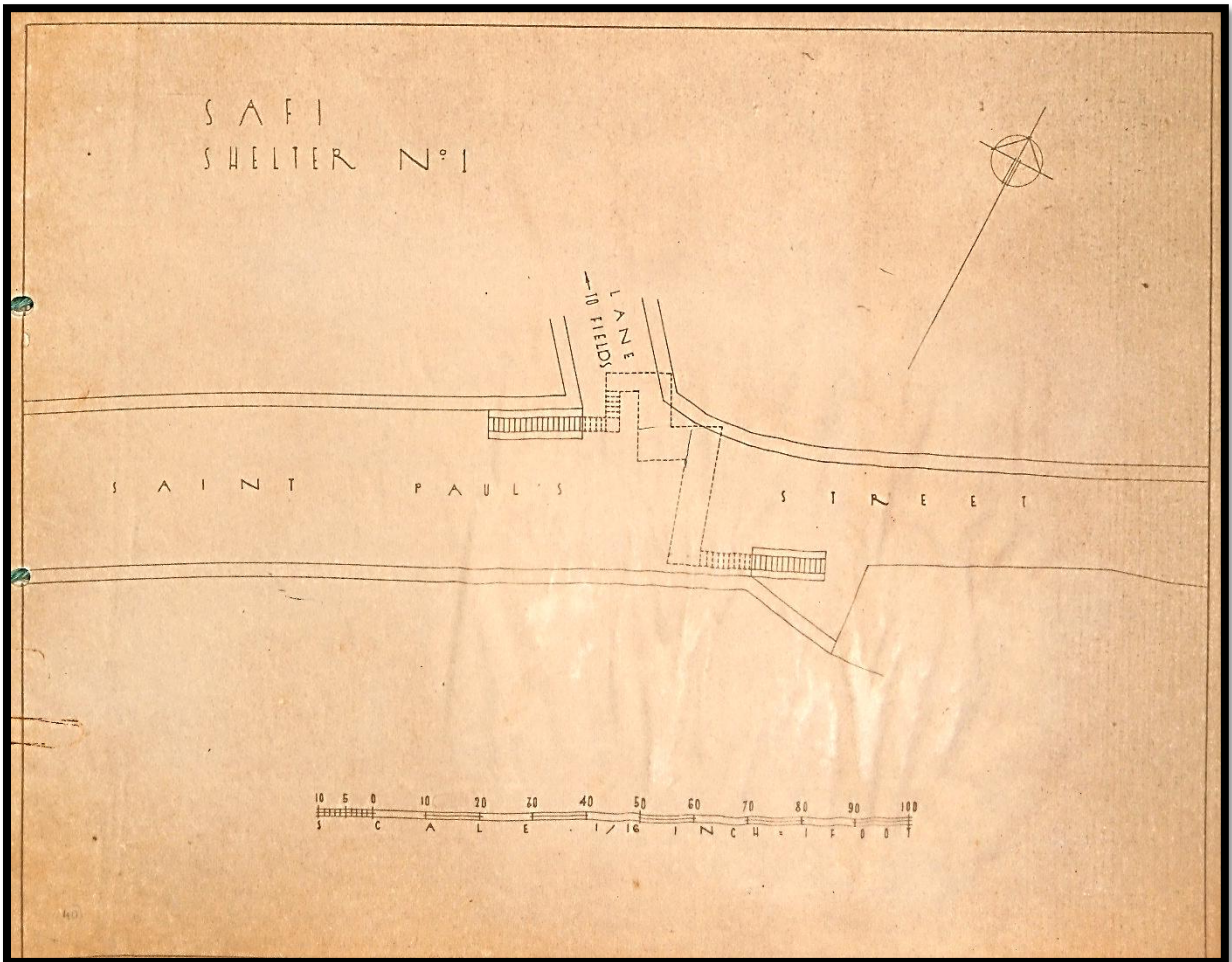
Planta do Abrigo nº1 "Saint Paul's Street – Lane to Fields"
